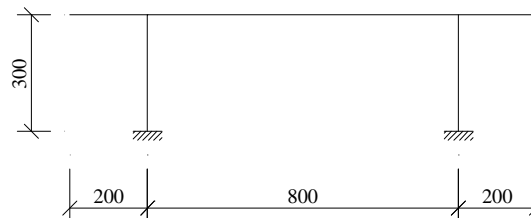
Pórtico composto de uma viga sobre dois pilares
